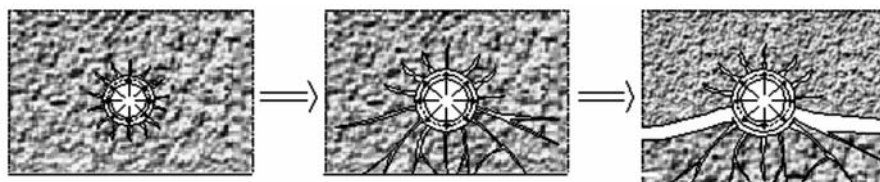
Fisurarea și dislocarea betonului în zona barei corodate
